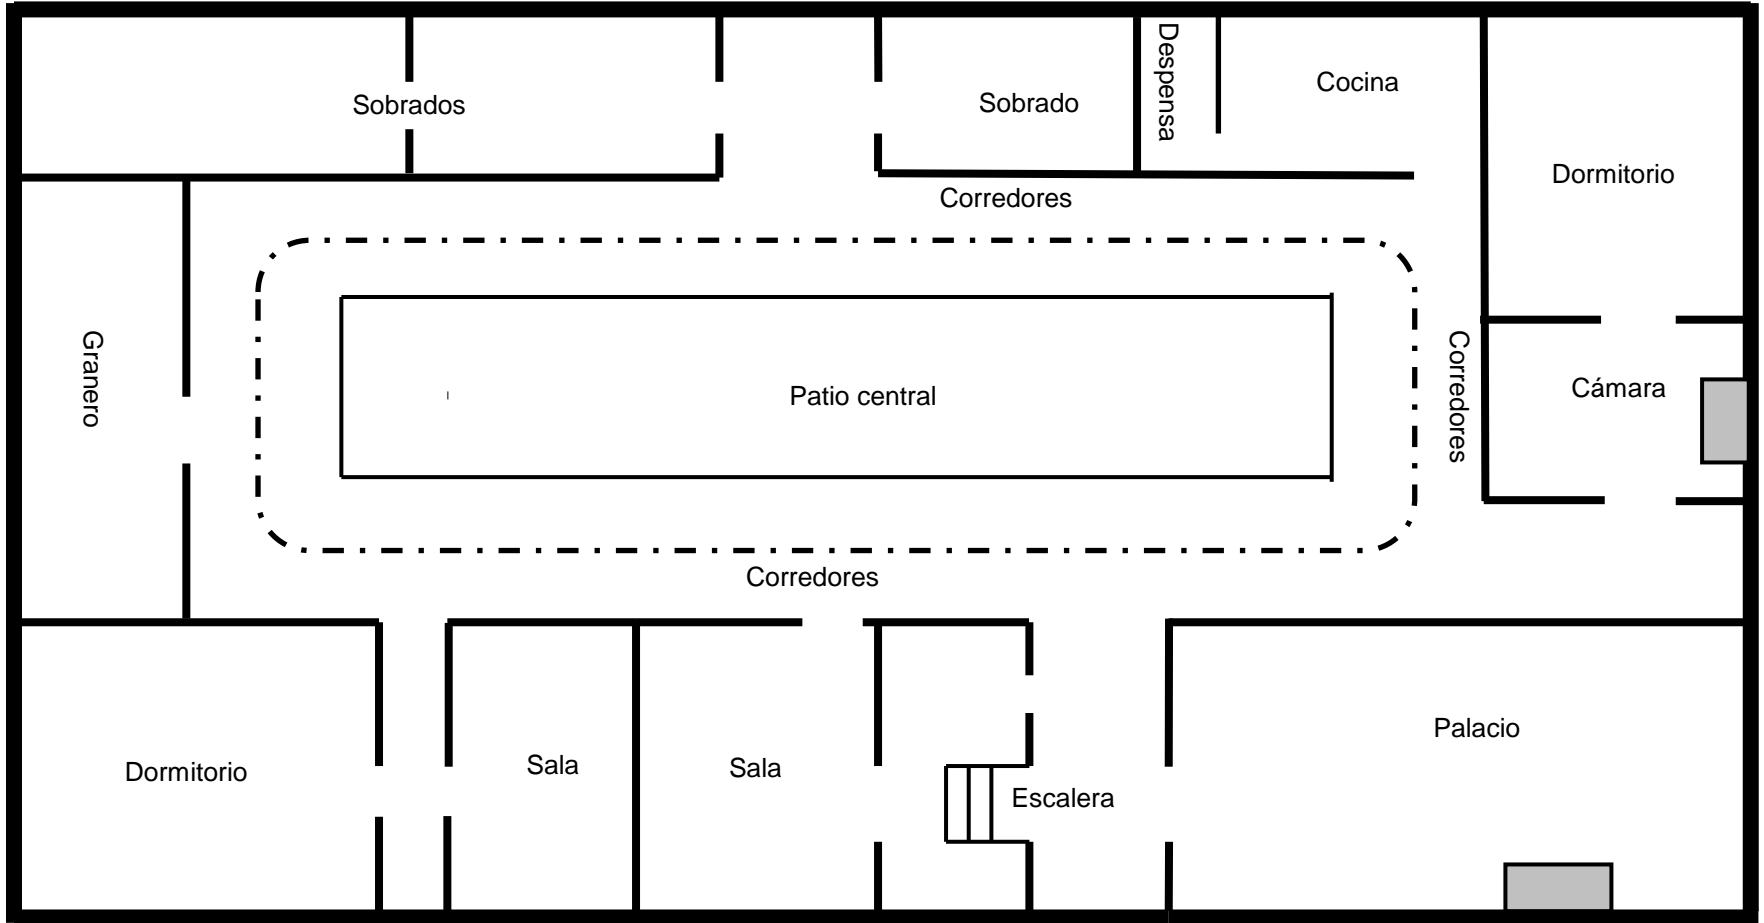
Plano de la planta superior del edificio con múltiples estancias.
